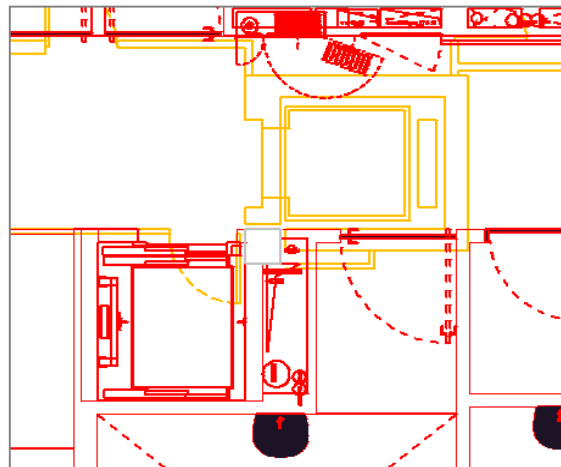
Caixas de elevador (a demolir e a construir) [10]
